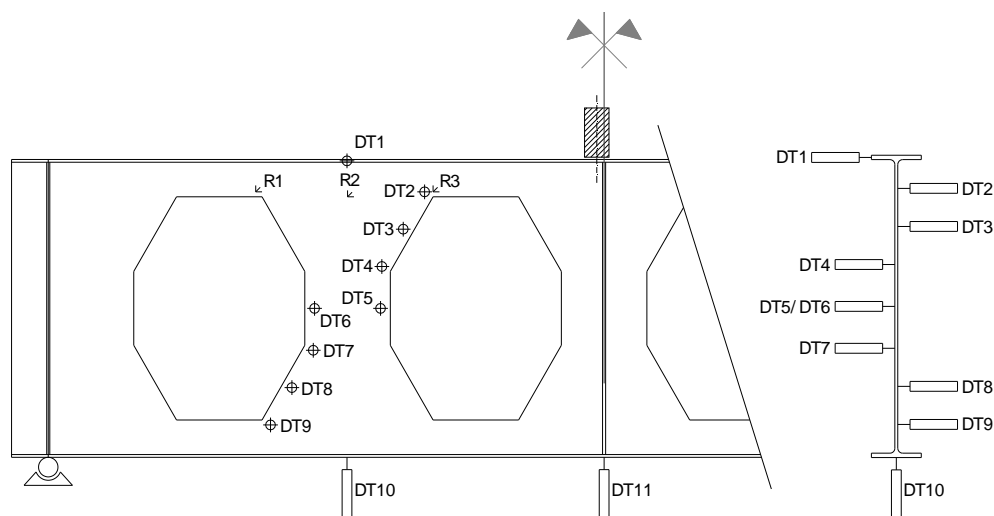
Projeto de instrumentação para as vigas do grupo C.
